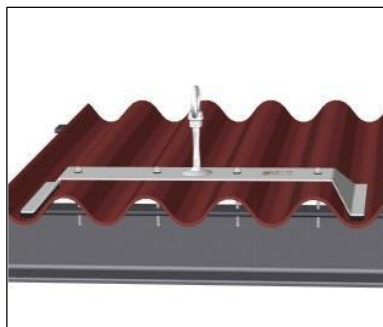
Anclajes en cubierta metálica. JOSE, LUIS. Anclajes para instalar cubiertas de fibrocemento. [En línea] 6 de Octubre de 2016. <http://acoher.es/anclajes-para-instalar-cubiertas-de-fibrocemento/>
